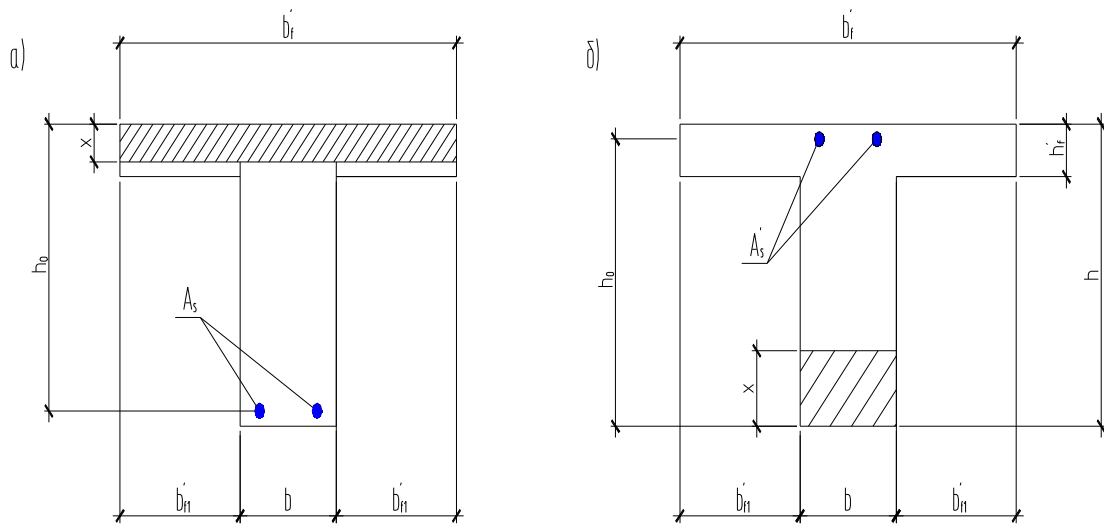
Розрахункові перетини другорядної балки:
